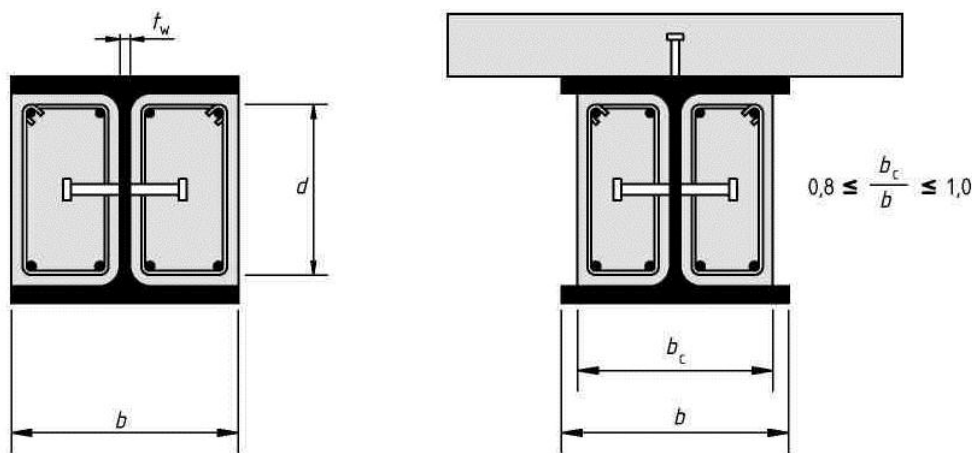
Поперечные сечения балок с обетонированной стенкой
